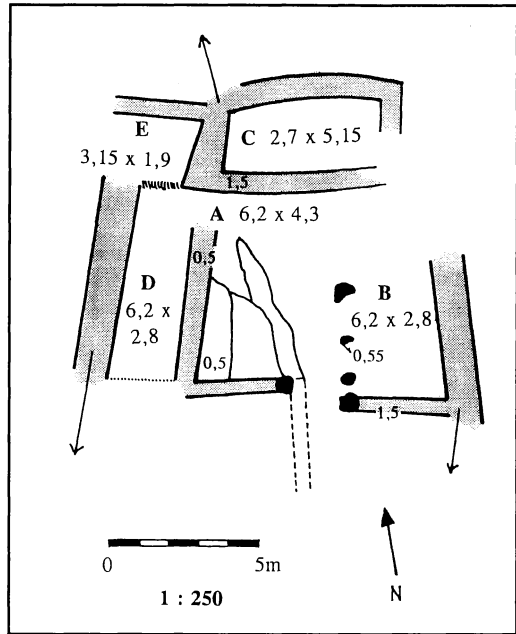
"Gilō": Grundriß "Gebäude 8"
